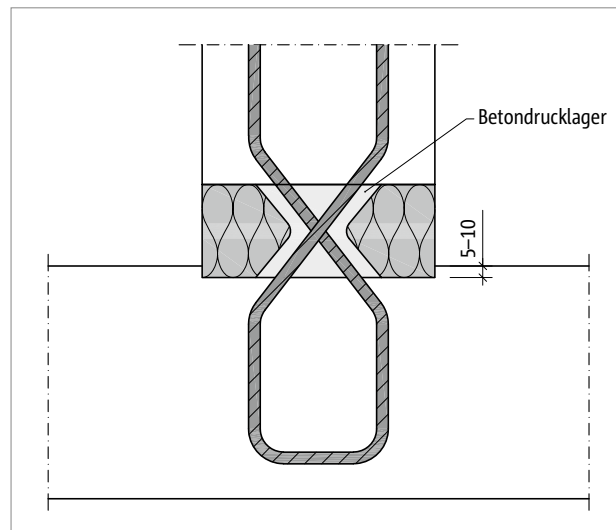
Schöck Sconnex® Typ W: Detail 1; Formschluss durch 5–10 mm tiefe Einsenkung des Dämmkörpers in die Decke
